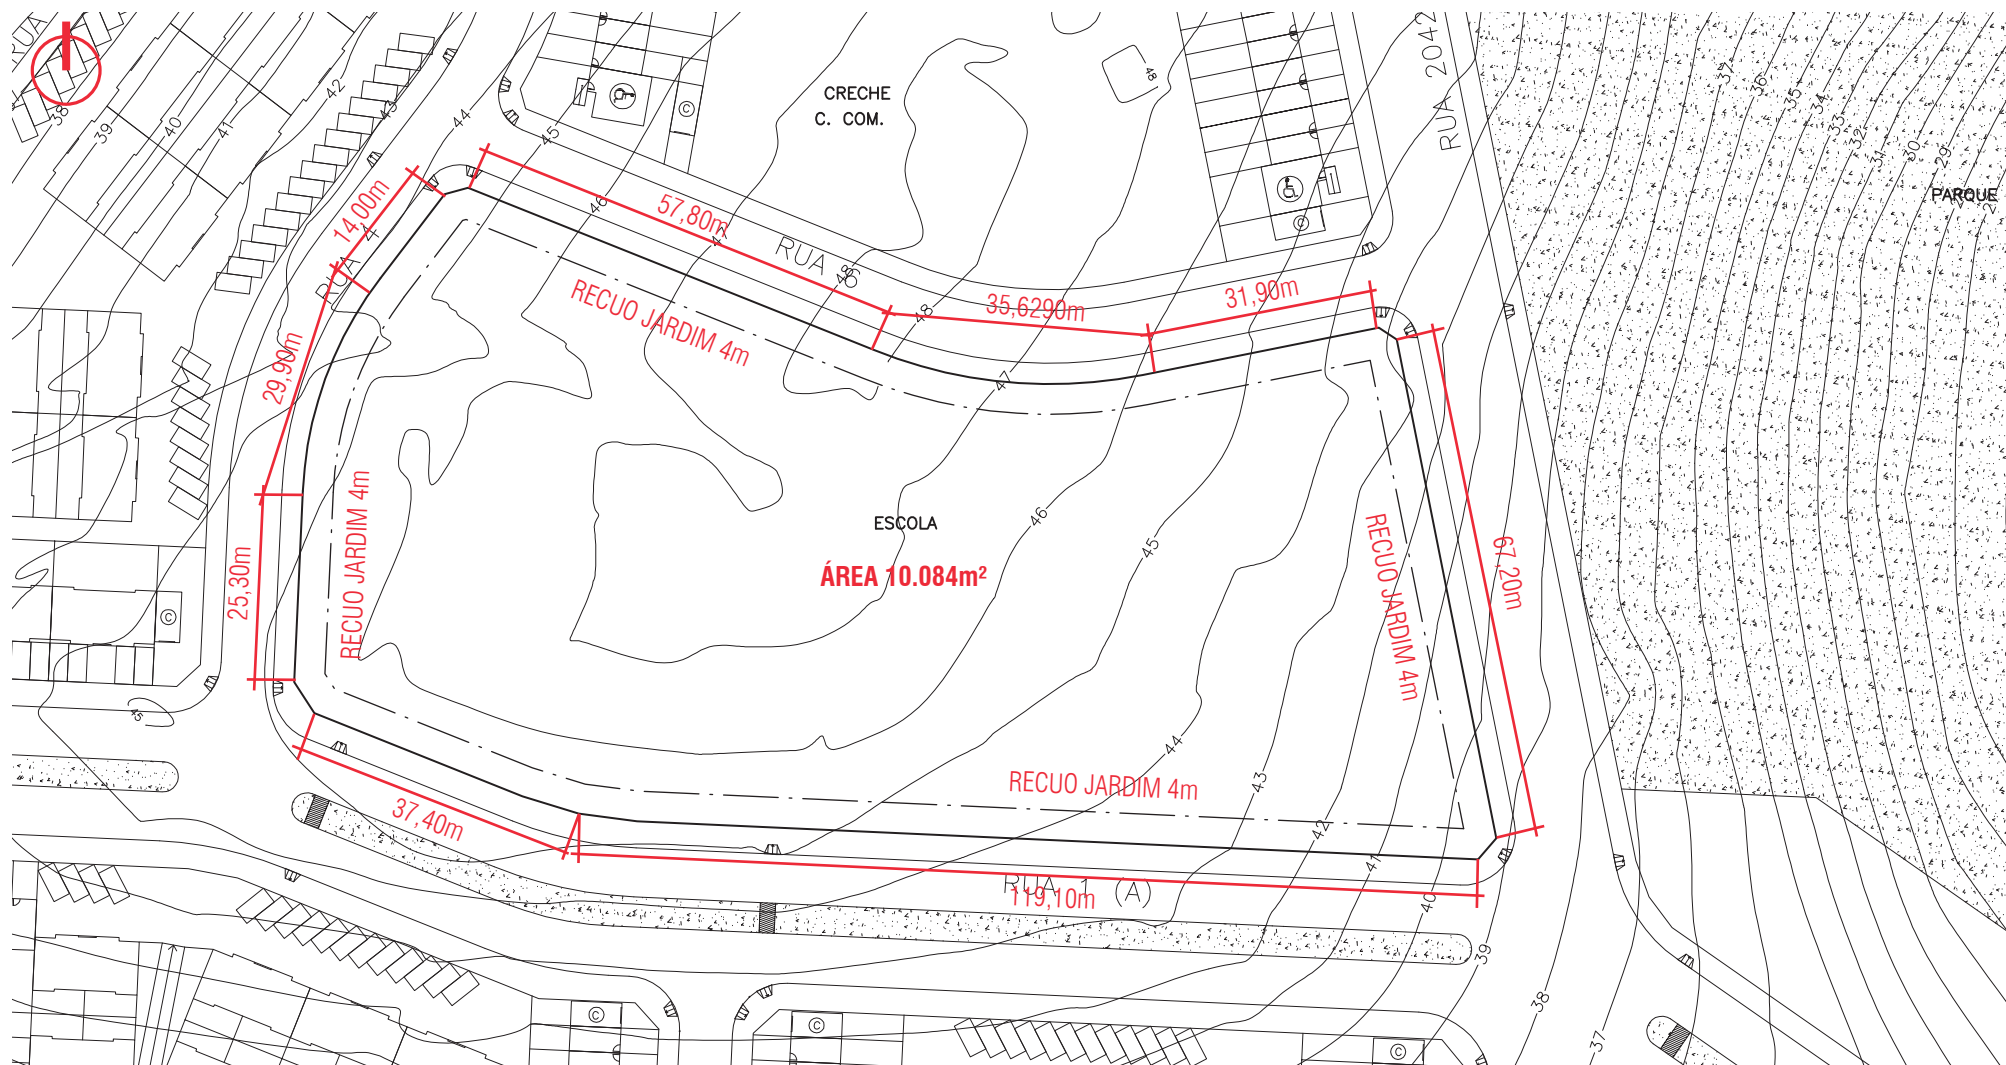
Levantamento plani-altimétrico | fonte: arquivo pessoal - escala 1:1.000
